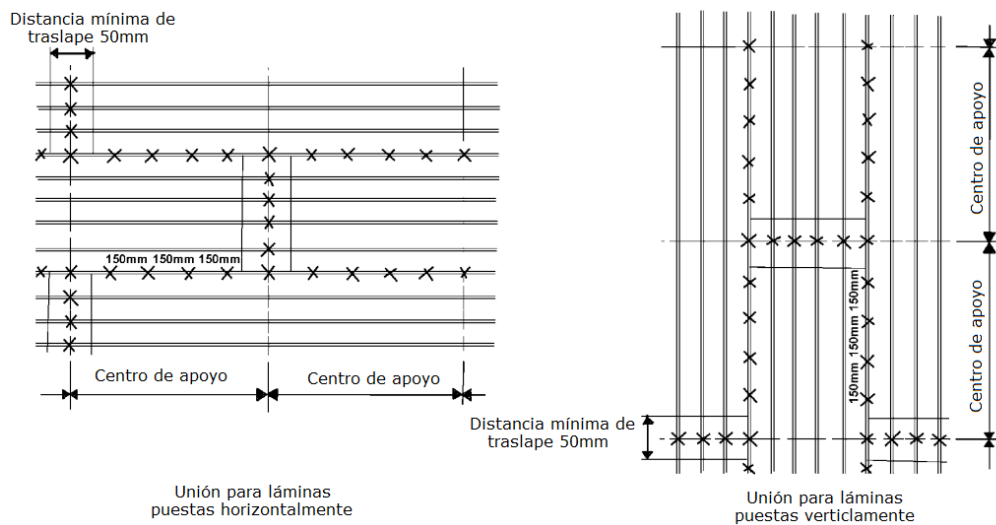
Forma de unir las placas del moldaje Hy - rib.
